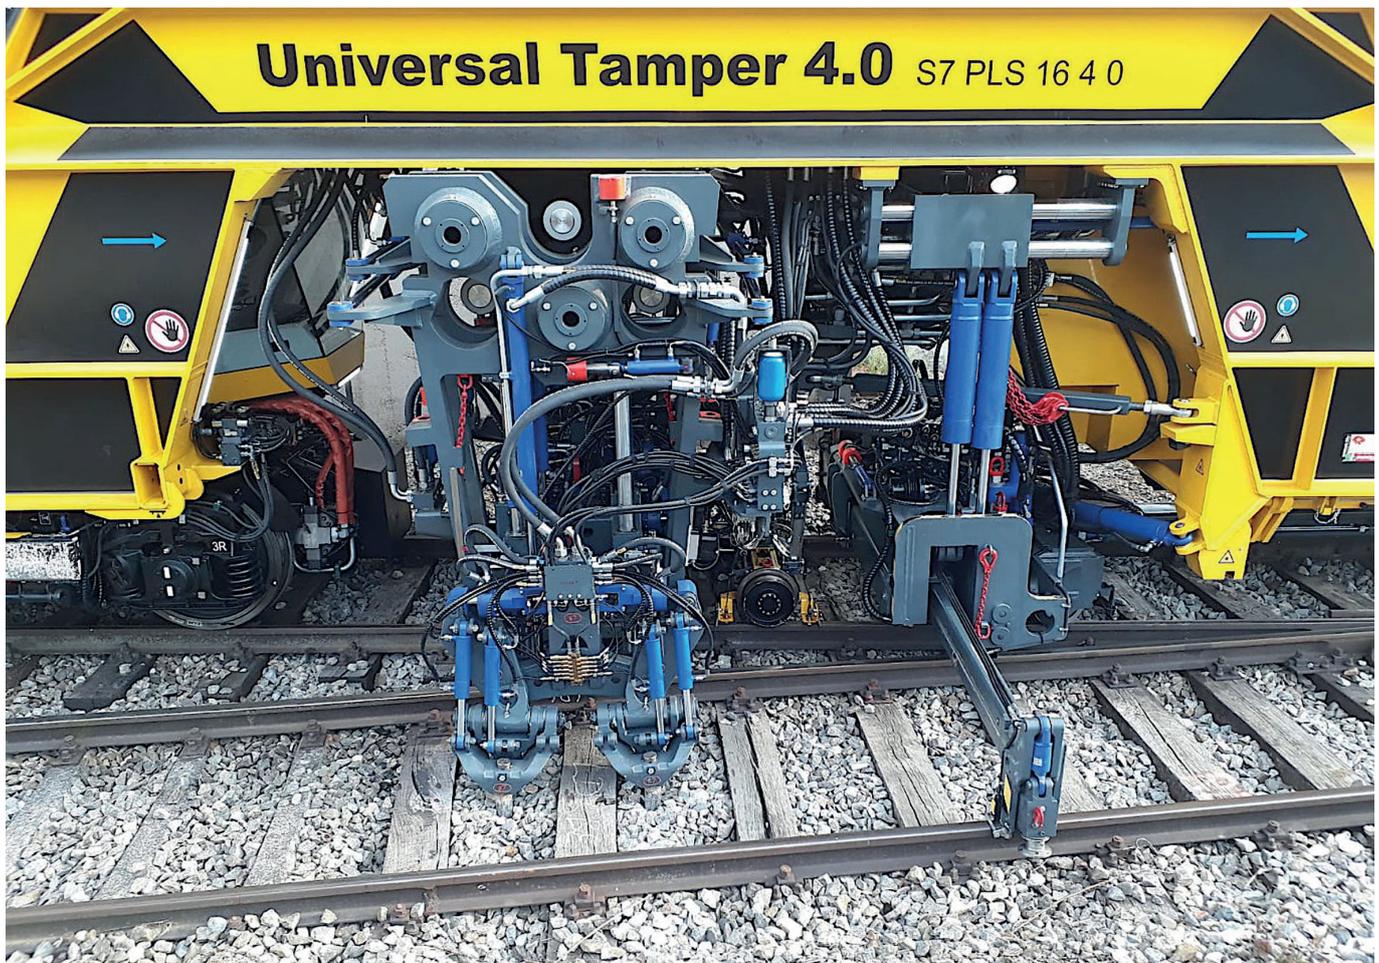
Universal Tamper 4.0 bei der Instandhaltung einer Weiche
